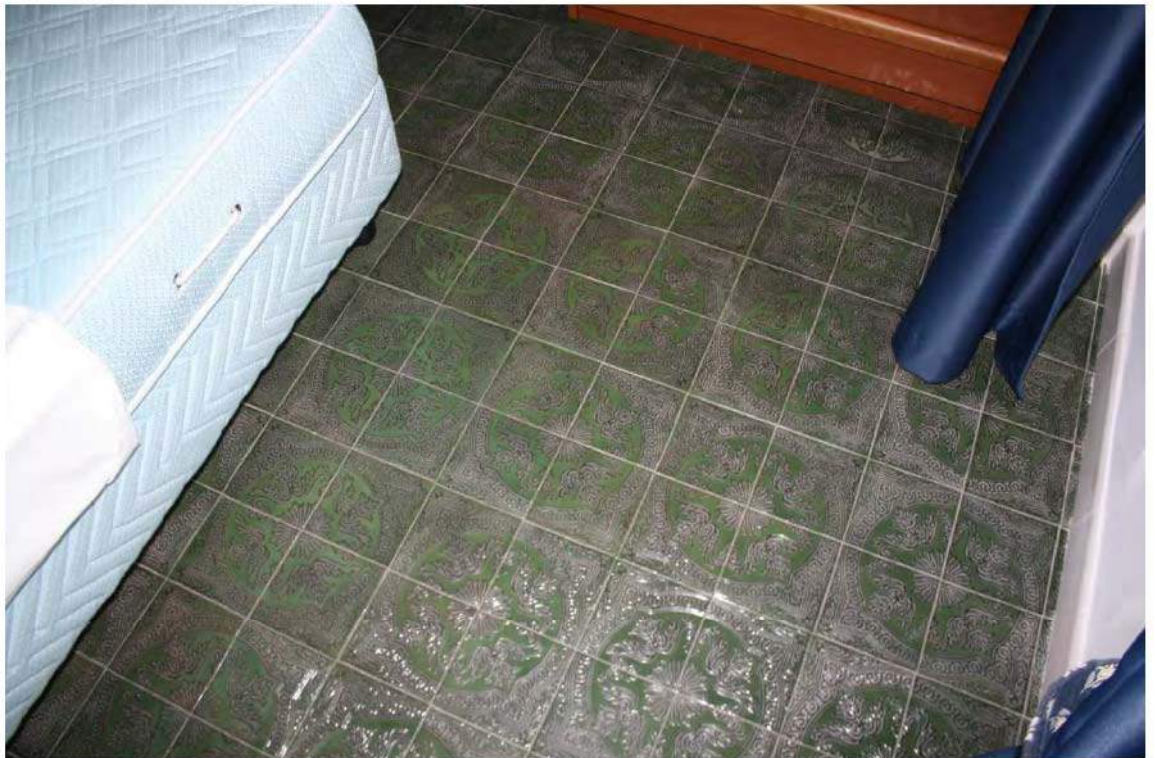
CAMERA DA LETTO TIPO DEL PIANO TERRA
